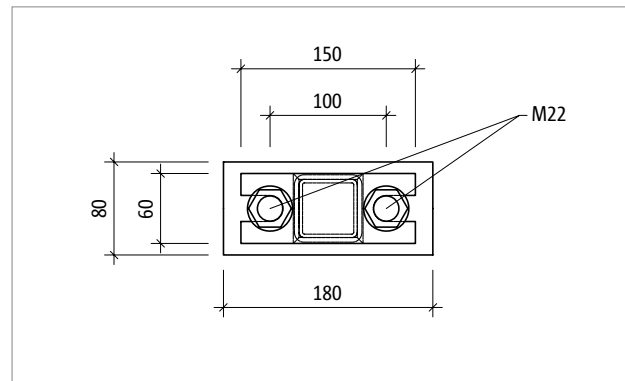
Schöck Isokorb® T type S-V-D16: Doorsnede
